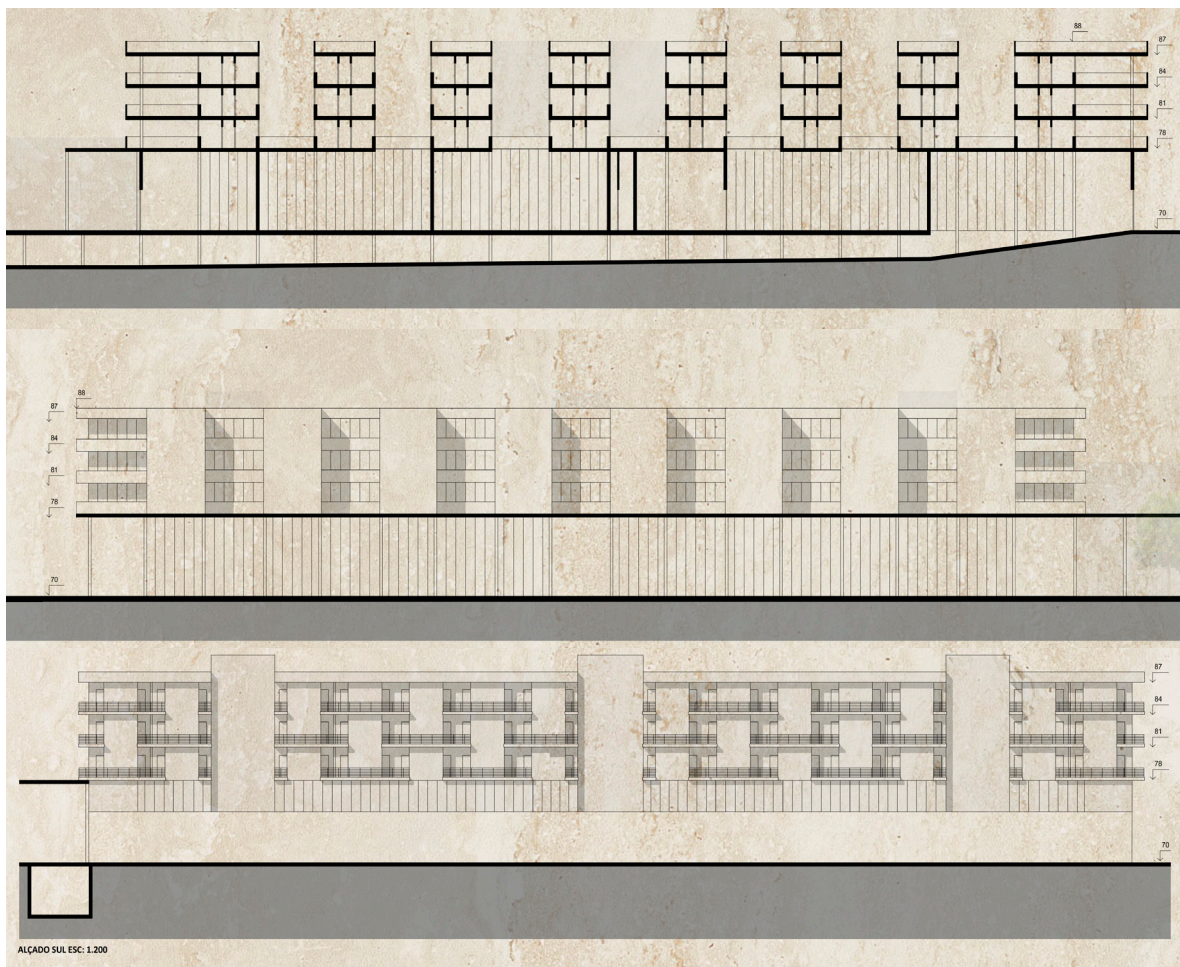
Corte GG' / Alçado Norte / Alçado Sul, esc: 1.200
